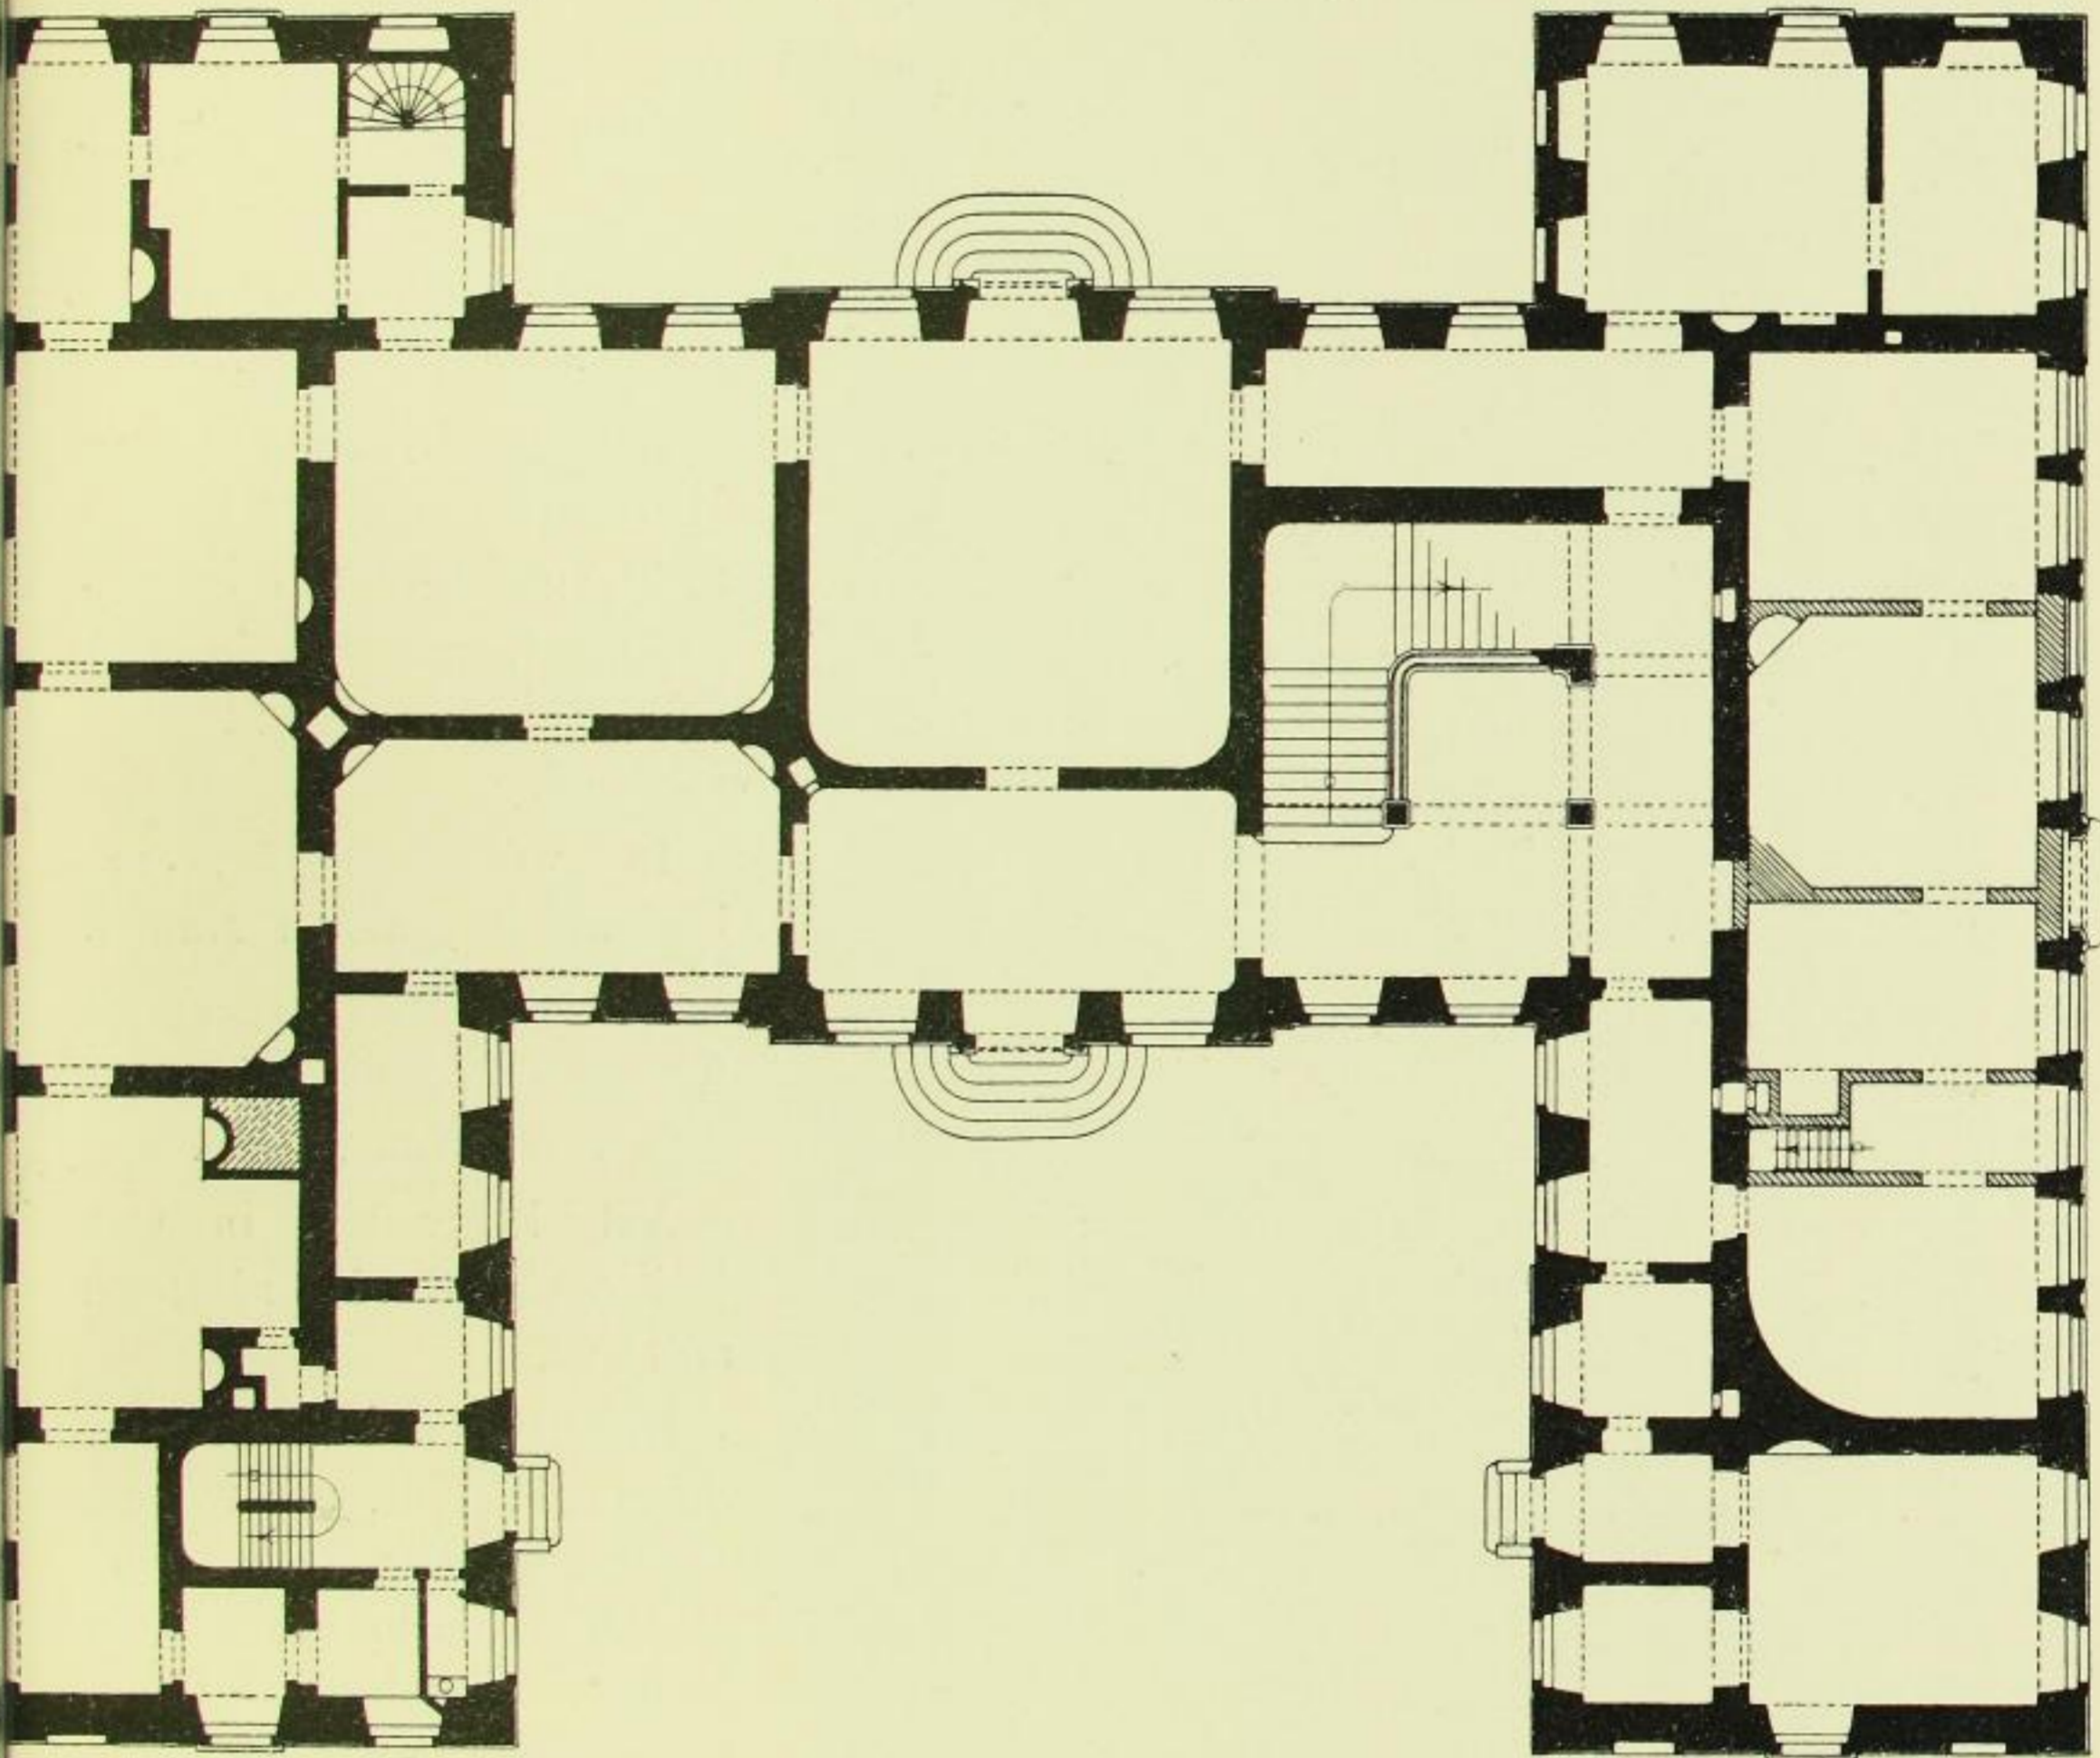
Dahlen, Schloß, Grundriß des Erdgeschosses.
